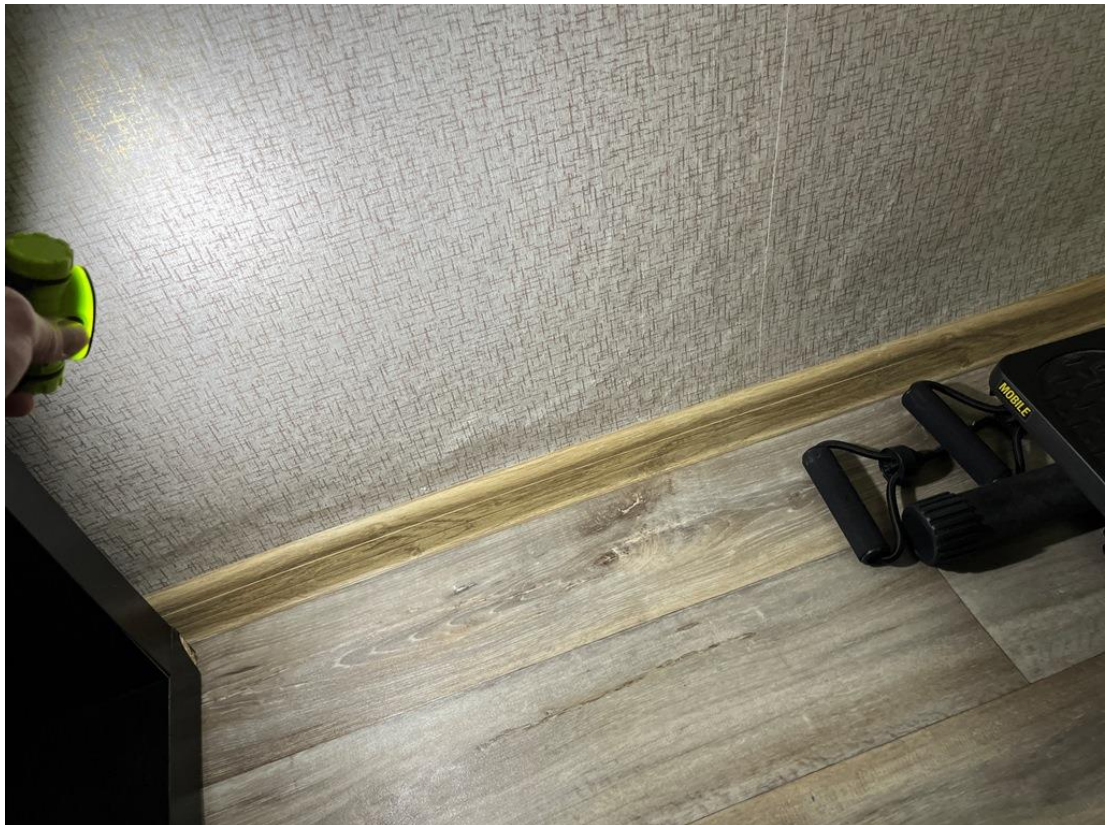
Увлажненная кладка, отслоение отделки в осях В-Д/7-9 1 этаж
